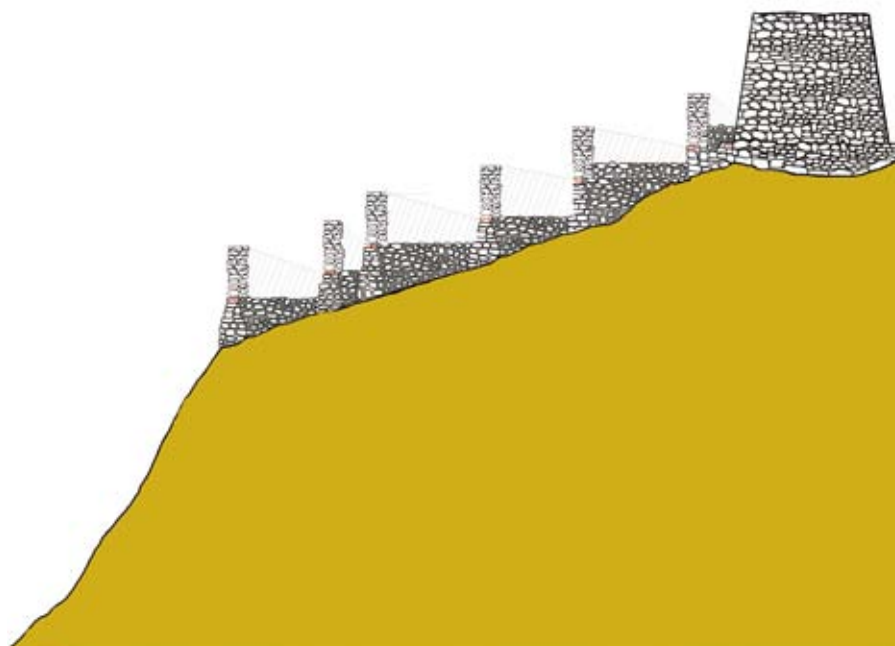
Reconstrucción teórica del perfil de la muralla con la torre.
